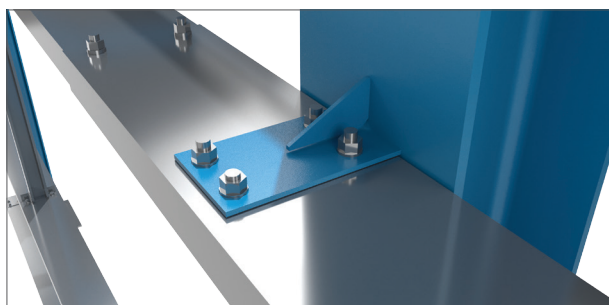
Stołki montażowe BOC zaprojektowane do przykręcenia do konstrukcji głównej / profile 142 - 262
